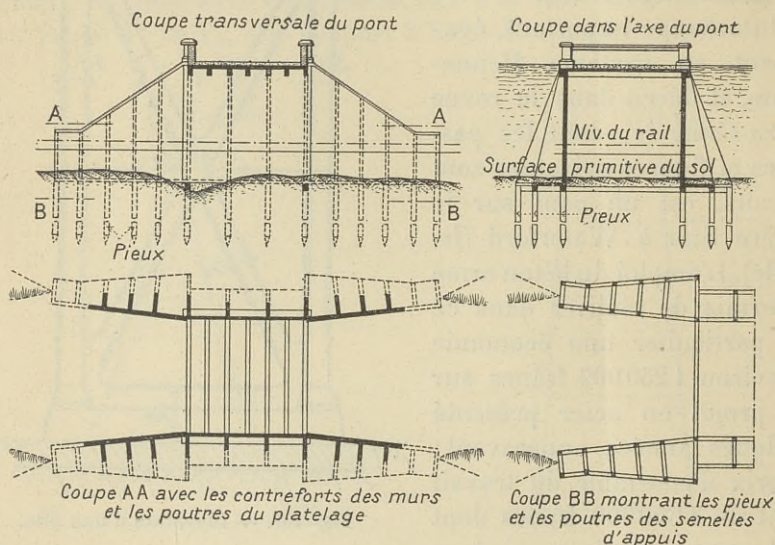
Pont-route avec culées et murs en aile entièrement en béton armé.
